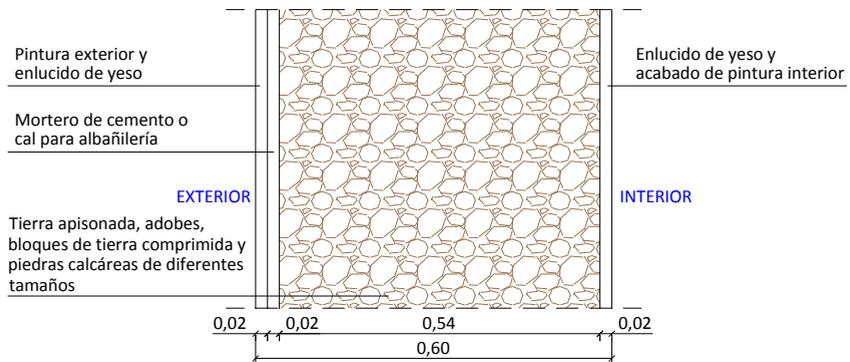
Detalle constructivo tipo del muro de la vivienda.
